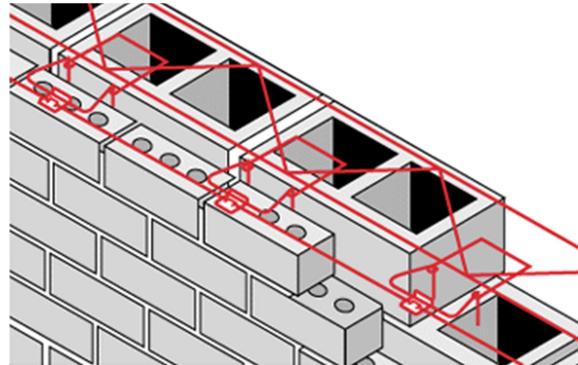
Плоские арматурные каркасы для соединения теплоэффективной части стены с облицовкой
